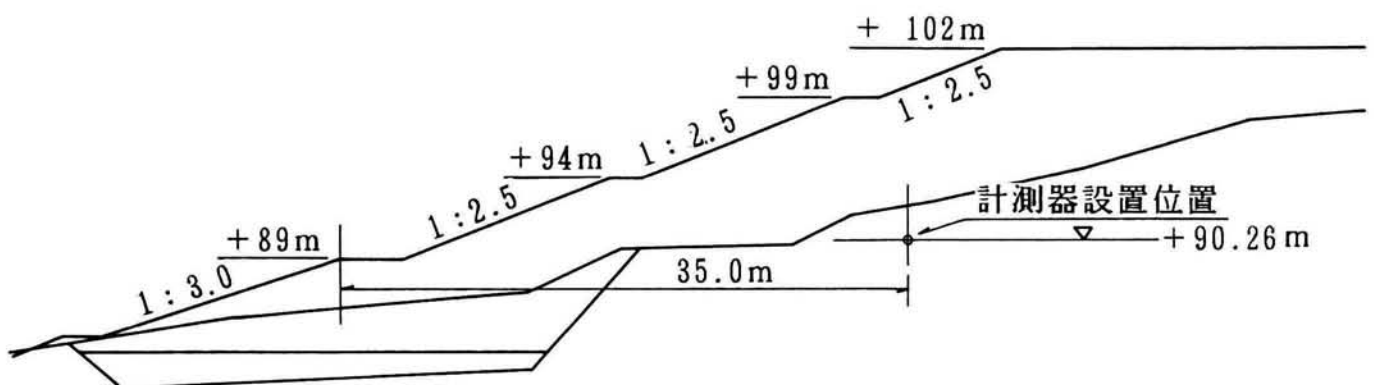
金沢大学角間団地基幹整備造成工事現場断面図
